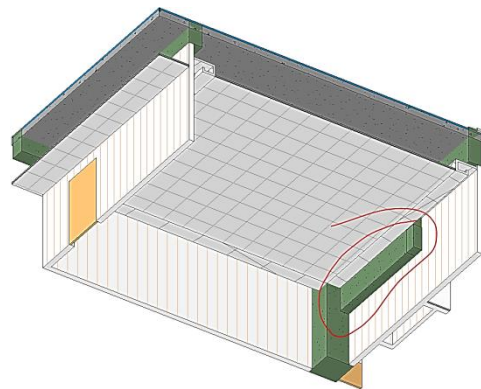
Viga de concreto expuesta bajo la cenefa y FCR.
